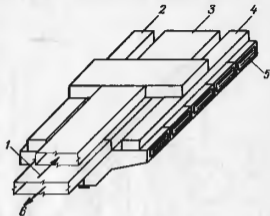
Возможная схема присоединения воздуховодов к ПВЛУ
